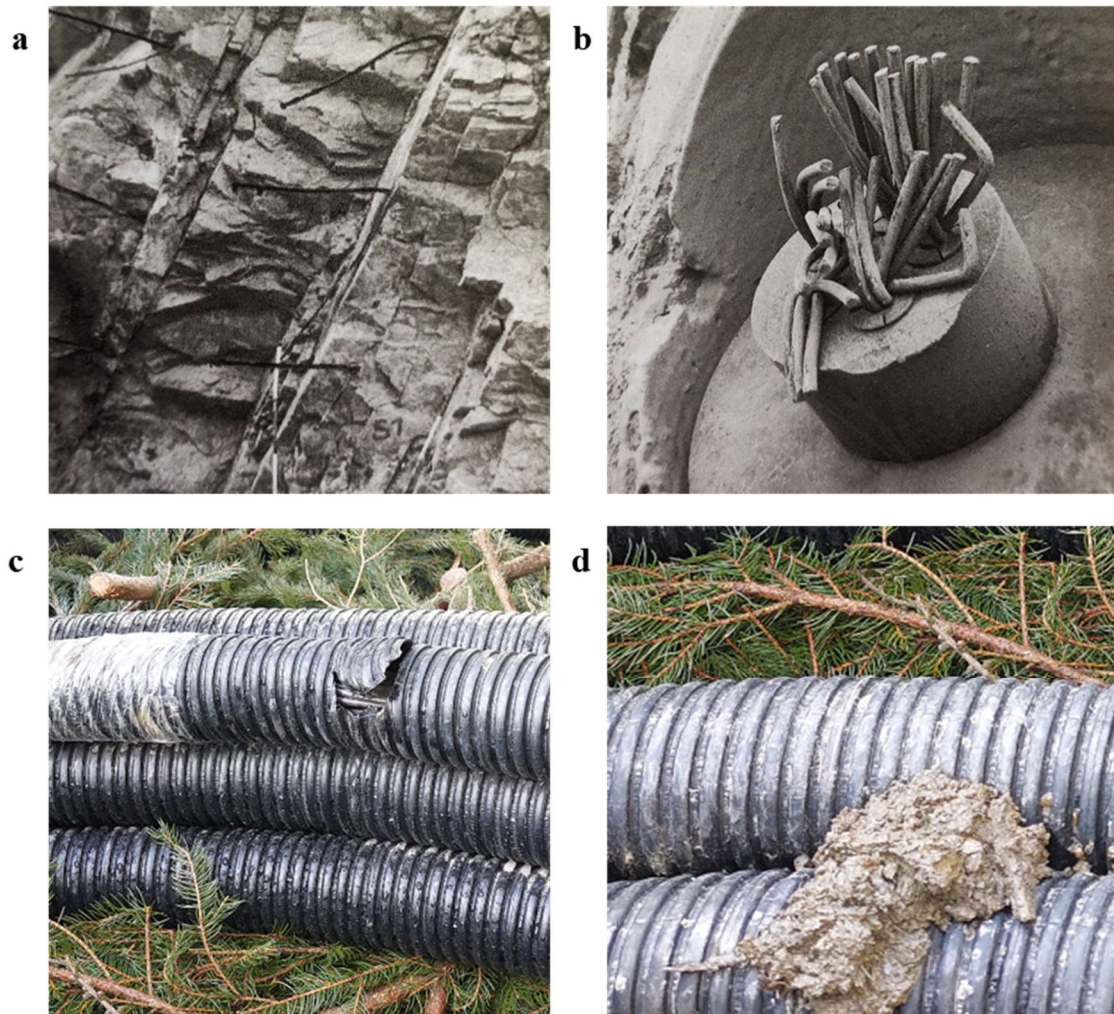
Beispiele für Beschädigungen durch den Baustellenbetrieb.
